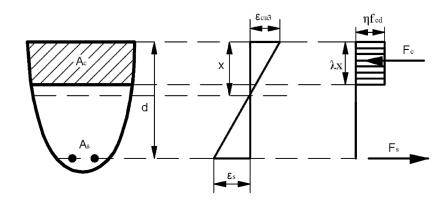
Прямоугольное распределение напряжений по высоте эффективной сжатой зоны сечения
